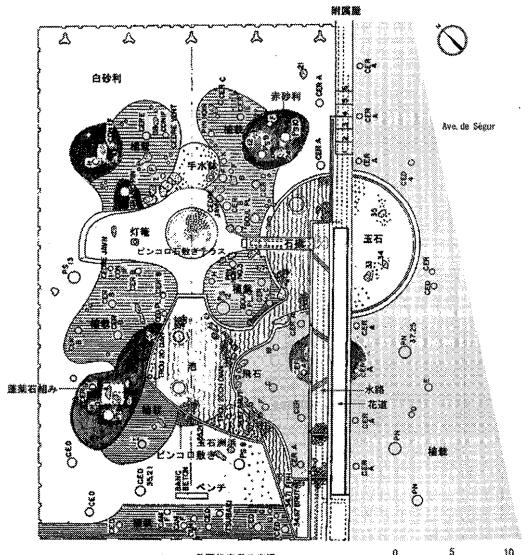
⁷³⁾ 日本庭園の平面図。約1,900m²。（田井・加工）
